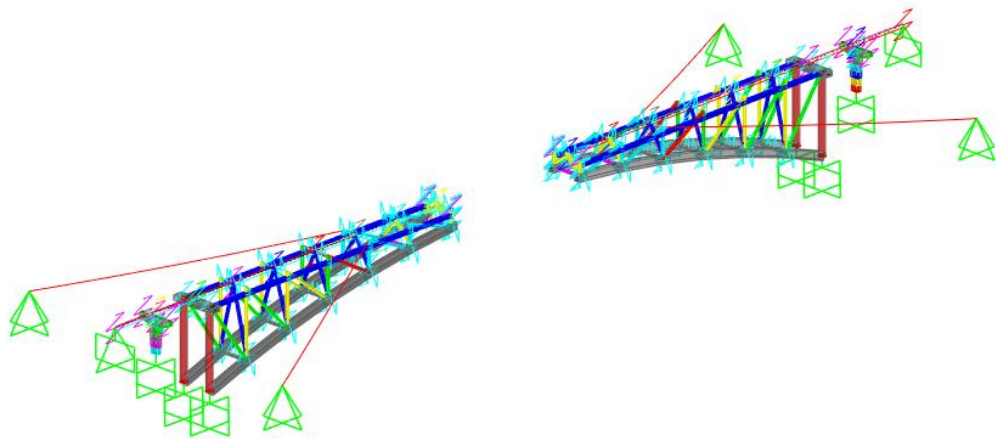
Modelo sísmico con cables en condición de máximo voladizo
